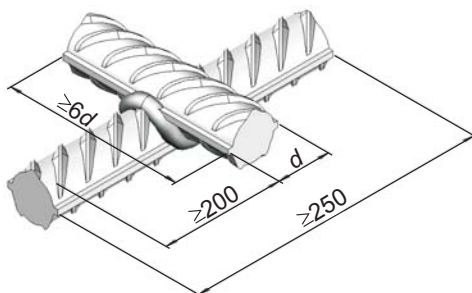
Контрольный образец крестообразного соединения для испытаний на срез
